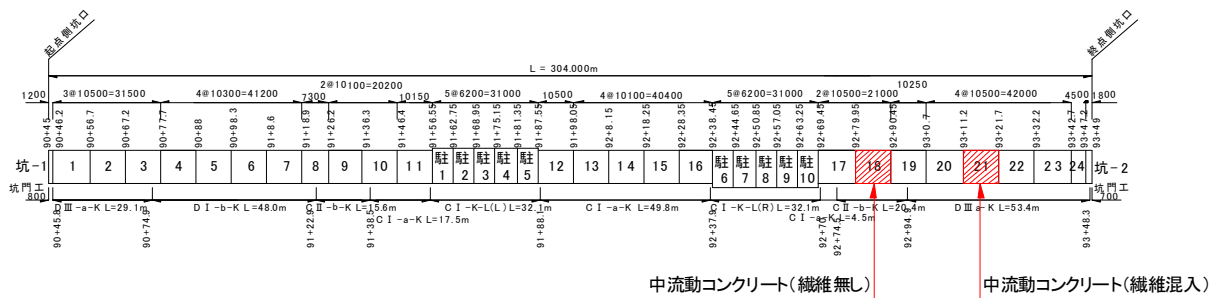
中流動コンクリート試験施工位置図（西河内トンネル覆工打割割図）
